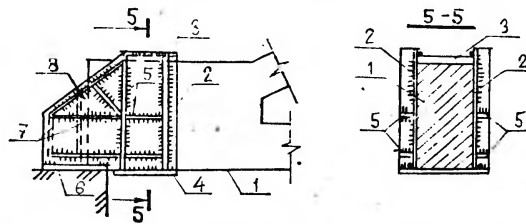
Устройство металлической обоймы для удлинения опорных частей ферм
